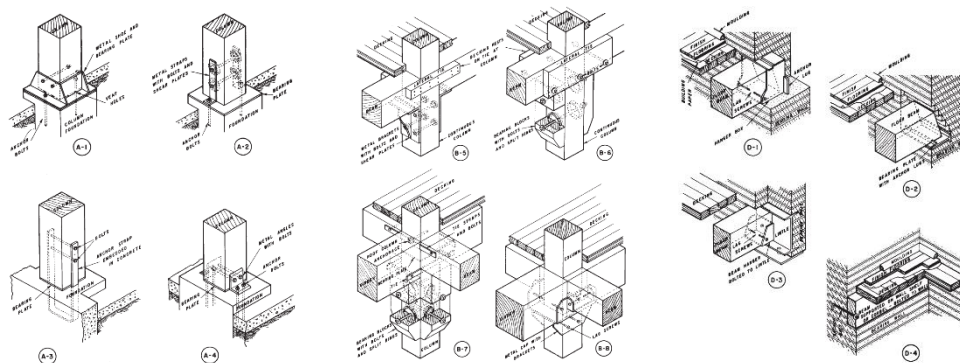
"Heavy Timber construction": Ancoragem dos pilares na laje de pavimento, ligações pilar-viga e ancoragem da estrutura do pavimento em paredes de alvenaria (AWC, 2003).
